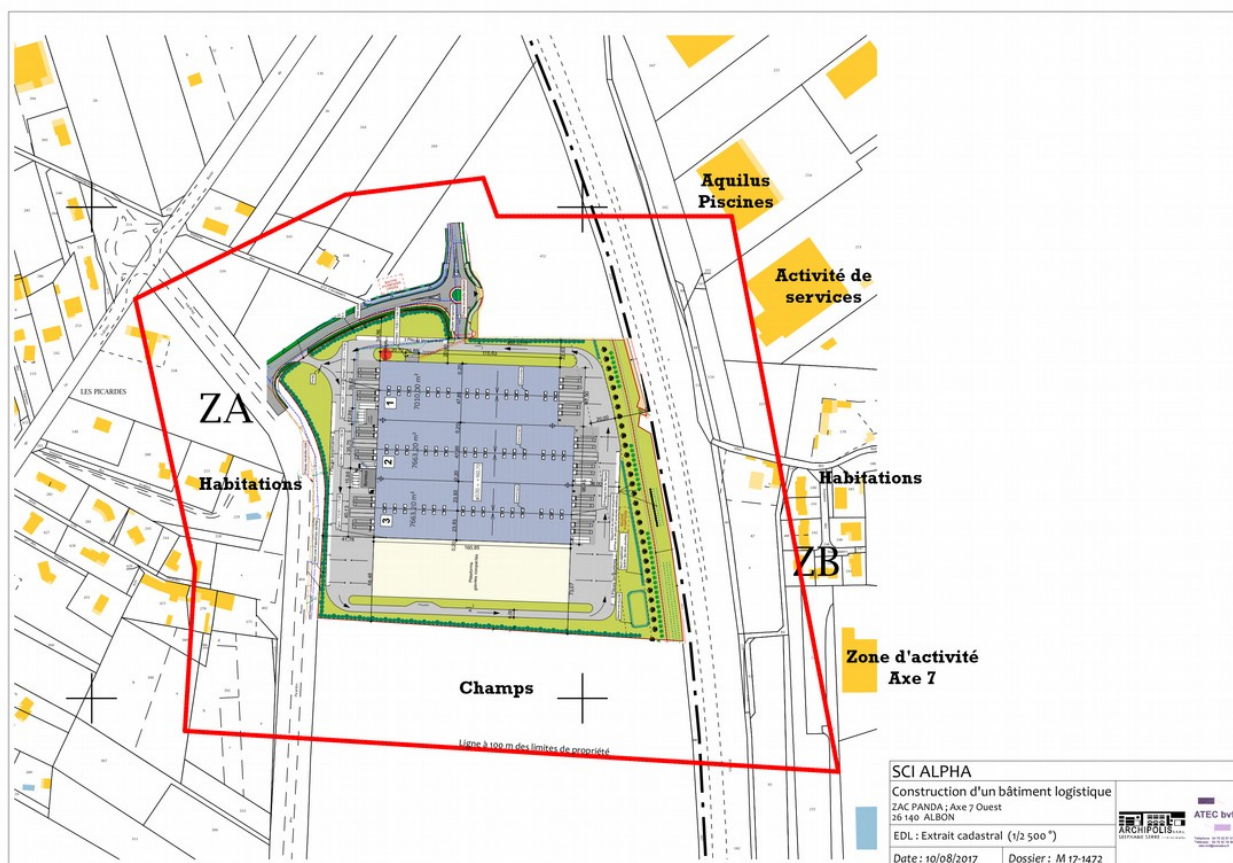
Extrait du plan cadastral de la demande d'enregistrement
